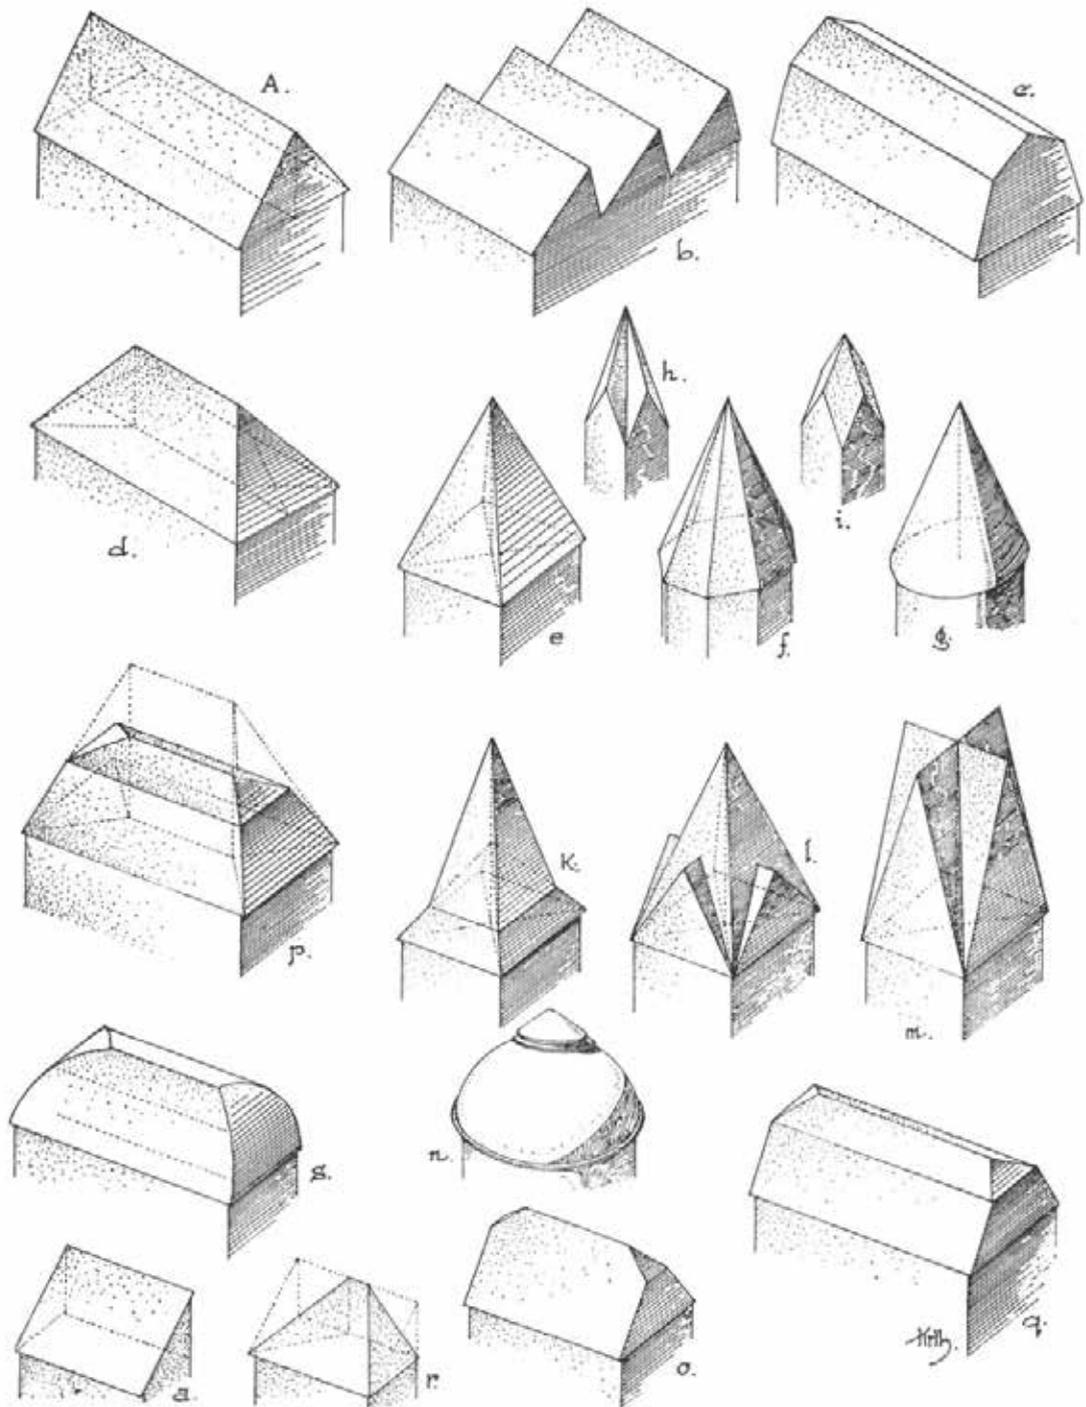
Aus dem Satteldach abgeleitete Dachformen.
